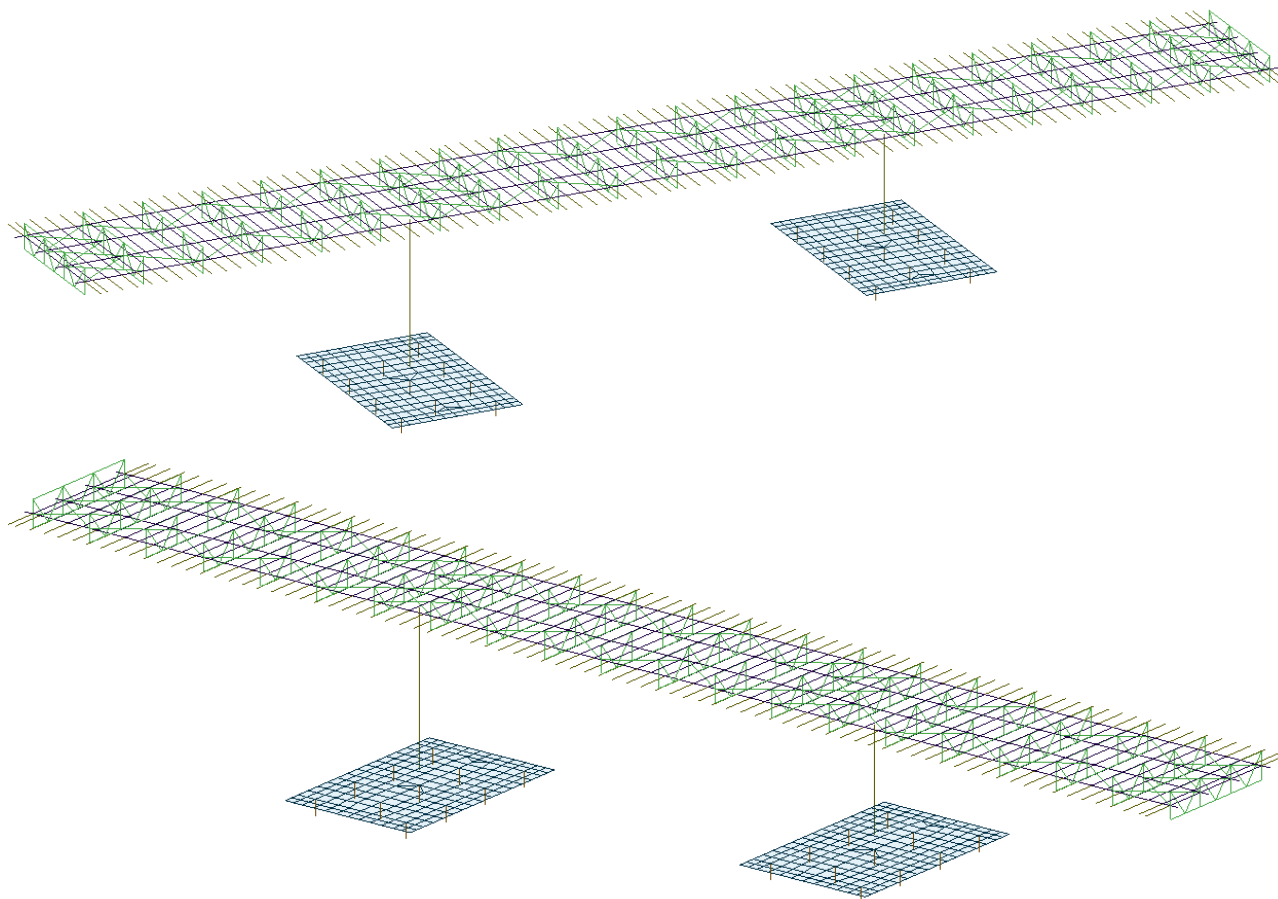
Modellazione tridimensionale Elementi finiti – Vista 3d wireframe
